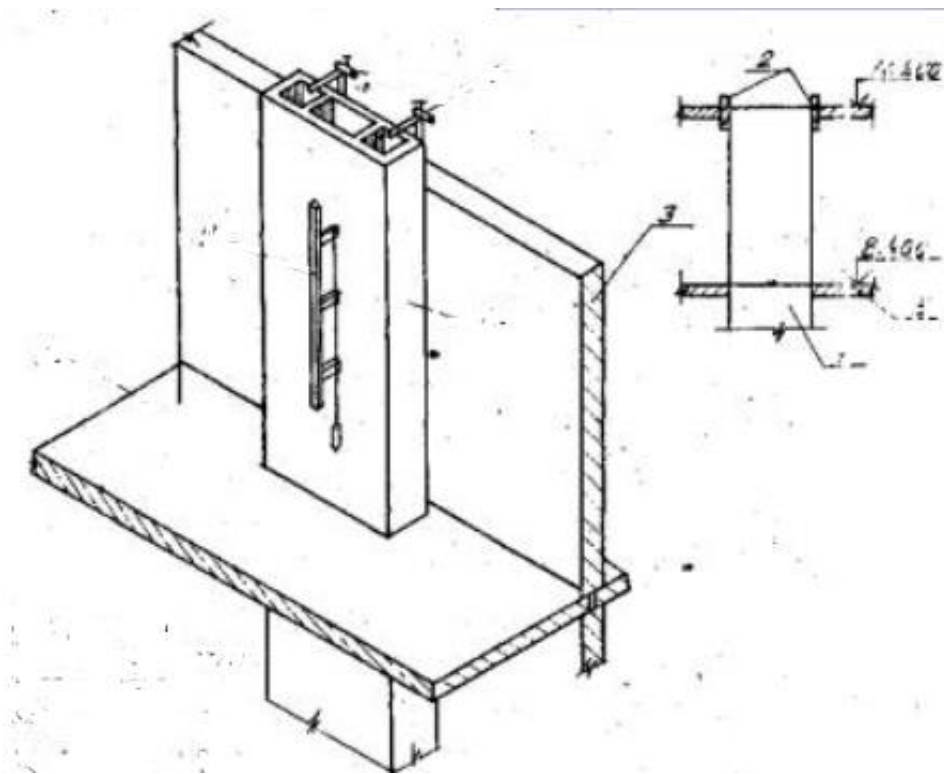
Схема тимчасового кріплення вентиляційного блоку до стінової панелі.
